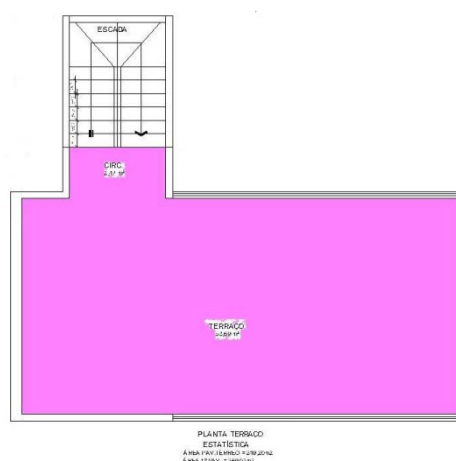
Projeto da planta baixa da residência Família Stroparo – 1973
